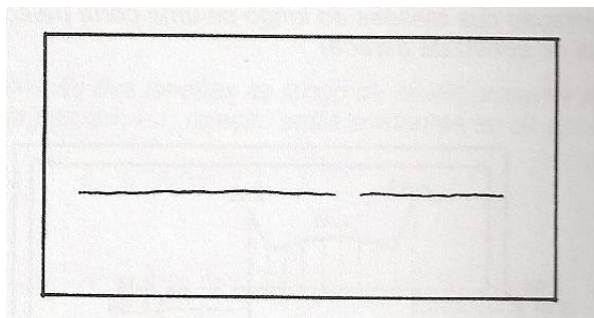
Fissura horizontal em alvenaria causada por sobrecarga.
